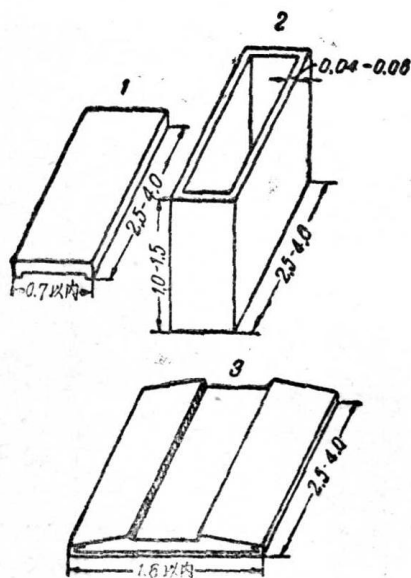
裝配式鋼筋混凝土基礎的結構（尺寸以公尺為單位）
